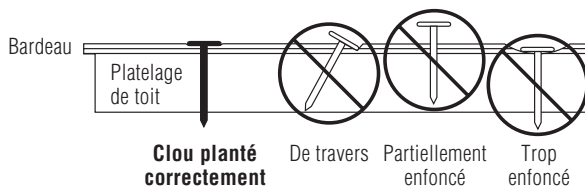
Clouage des bardeaux à trois languettes en bande.
